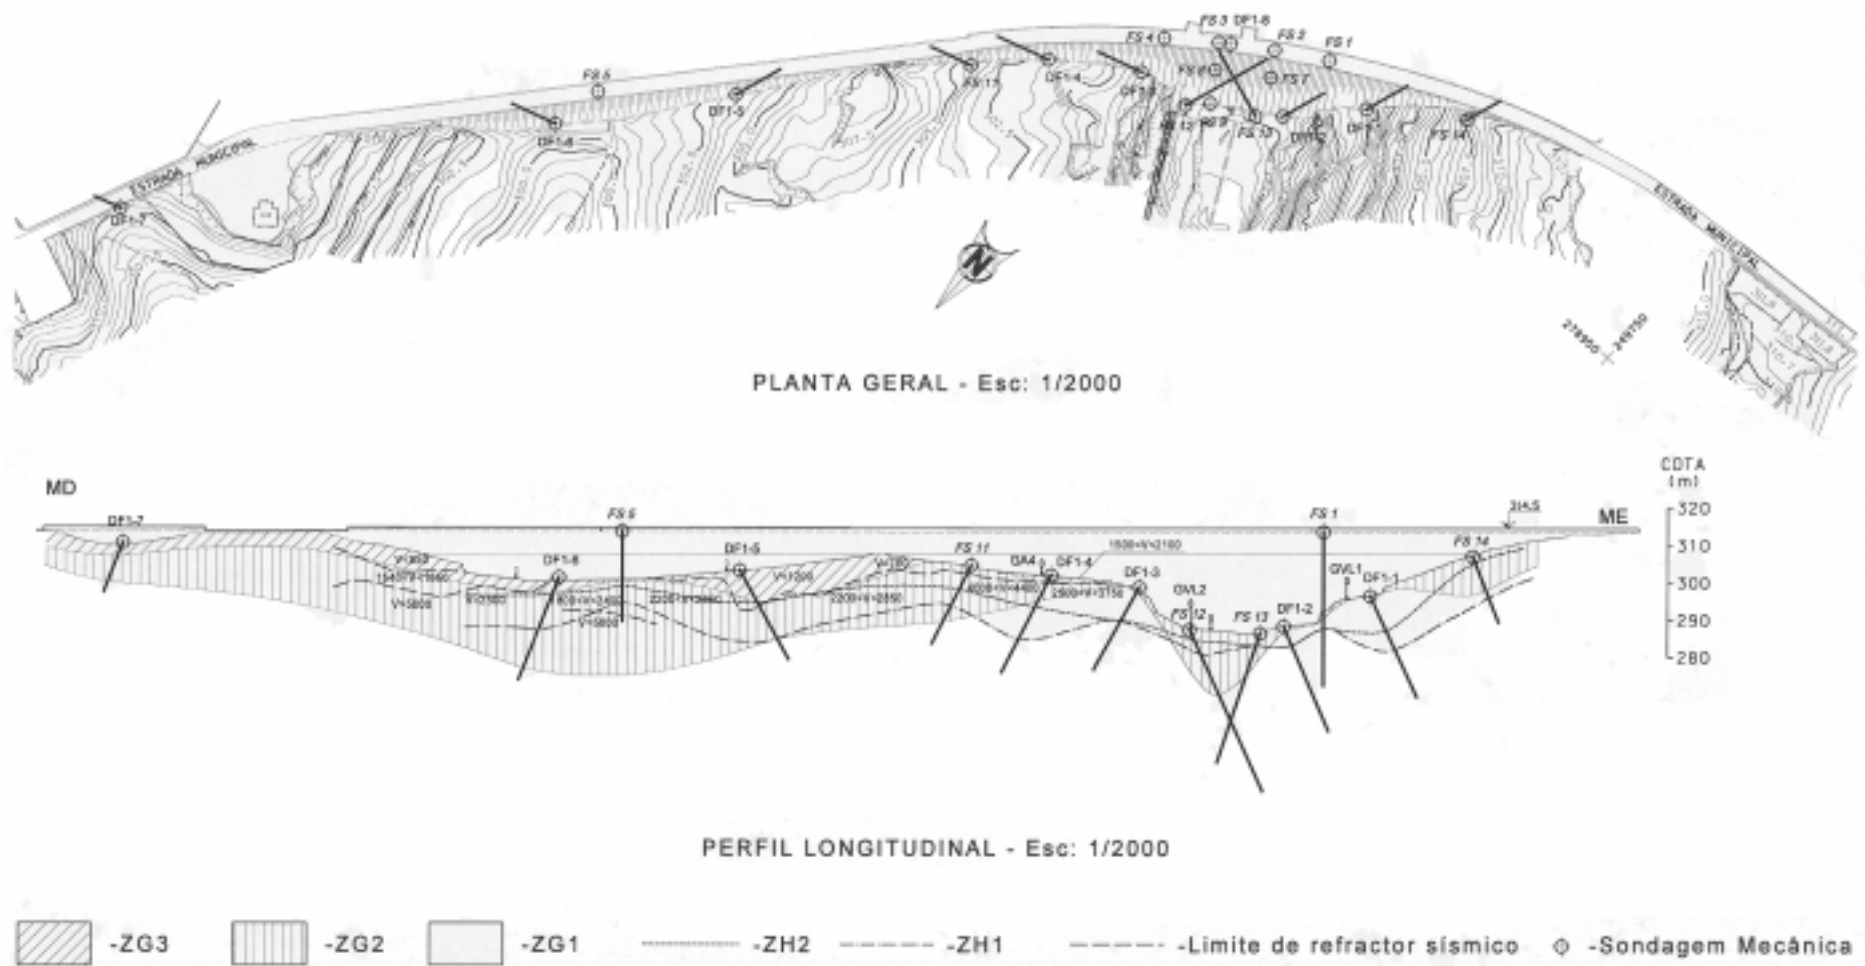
Planta de localização dos trabalhos de prospecção mecânica e corte geológico-geotécnico pelo pé de jusante da barragem.
